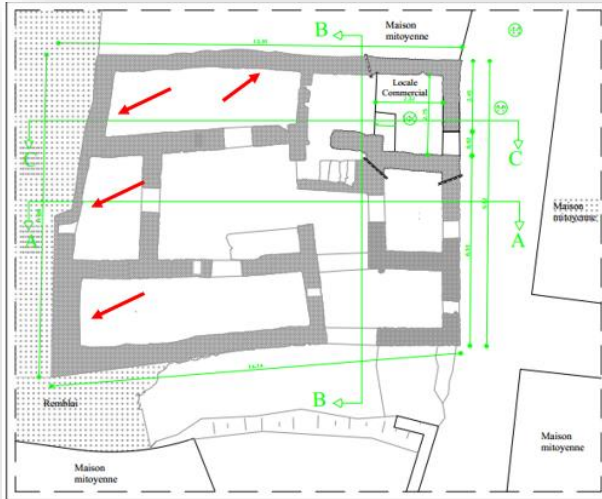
Plan RDC de la maison 10 où il est indiqué l'emplacement du drain intérieur.
